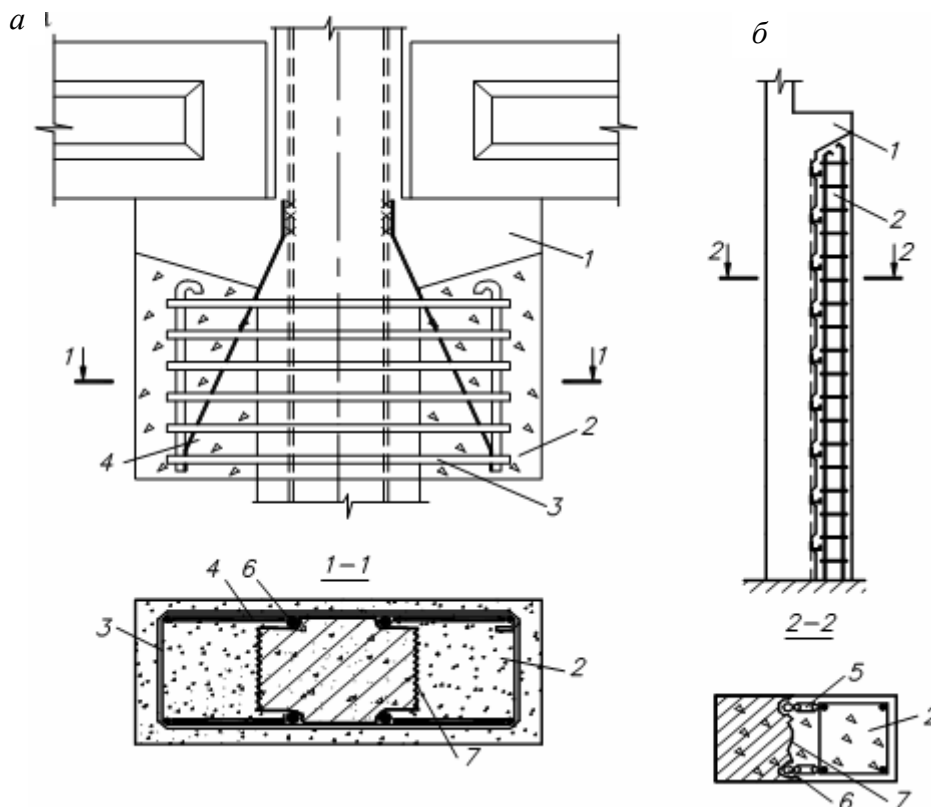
Усиление коротких консолей колонн: а – наращиванием; б – наращиванием по длине подконсольной части: 1 – усиливаемая консоль, 2 – бетон наращивания, 3 – замкнутая арматура, 4 – наклонная поперечная арматура, 5 – скобы, 6 – оголенная арматура колонны, 7 – насечка
